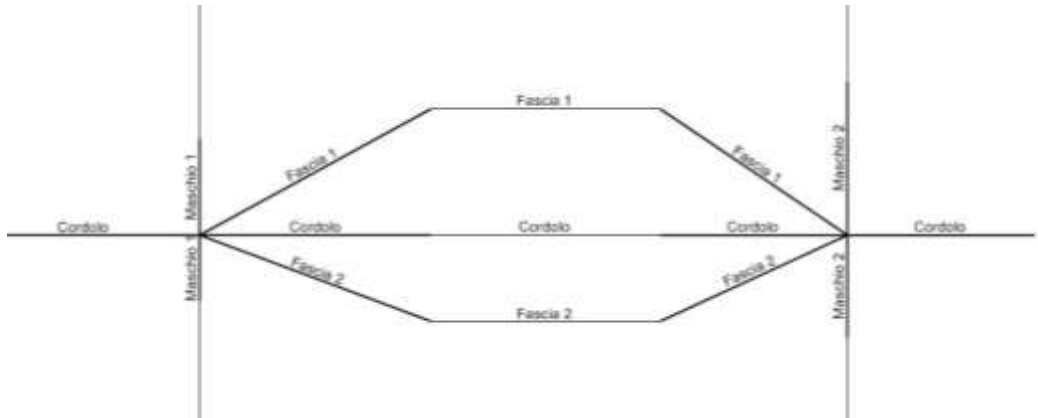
Schematizzazione di un collegamento fra maschi e fasce murarie
